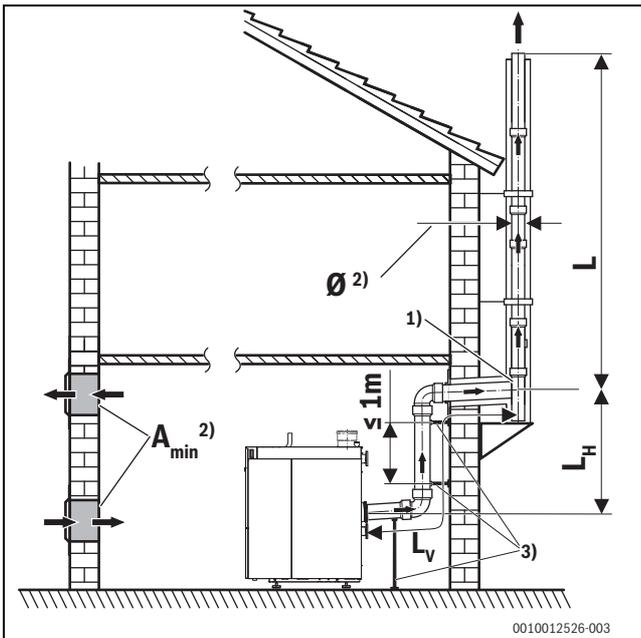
Abgasführung ohne Schacht, Fassadensystem, Variante 4
